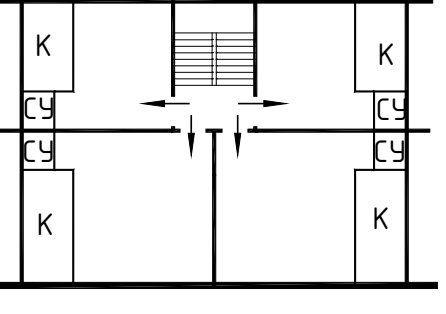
ИЗОБРАЖЕНИЕ САУЗЛА НА ПЛАНЕ ЭТАЖА
